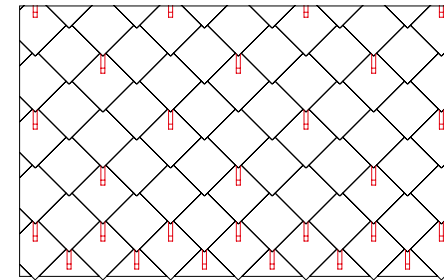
· Verlegeschemen mit dem Schneestopper für die Dachraute 29×29
